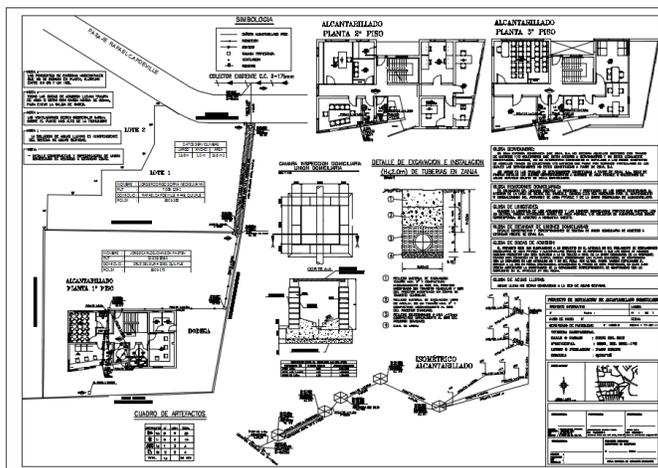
Diseño de agua potable y alcantarillado de edificio
